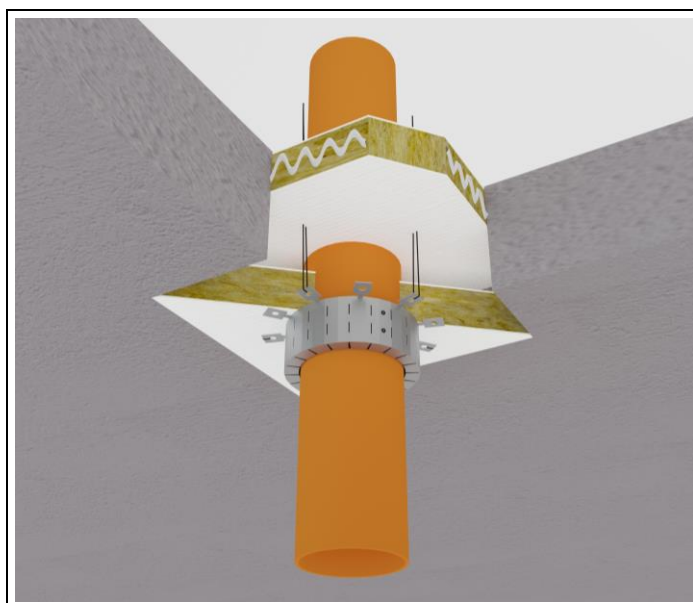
Ejemplo de KF-Multicollar fijado con cables de acero en suelos.
